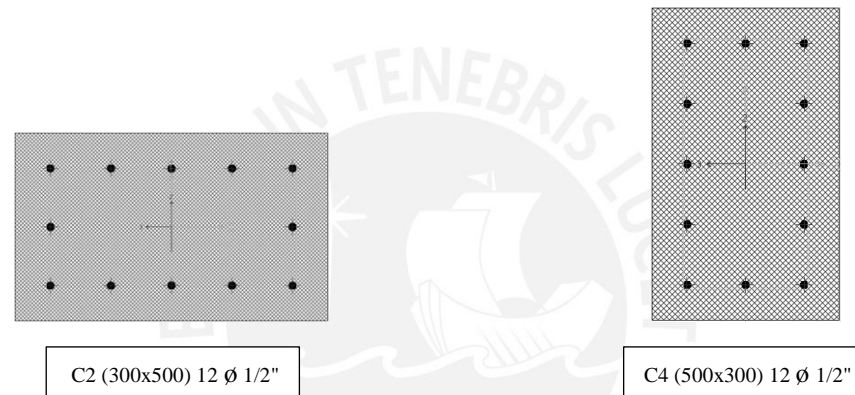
Dimensiones y refuerzo longitudinal de columnas C2 (derecha) y C4 (izquierda).
